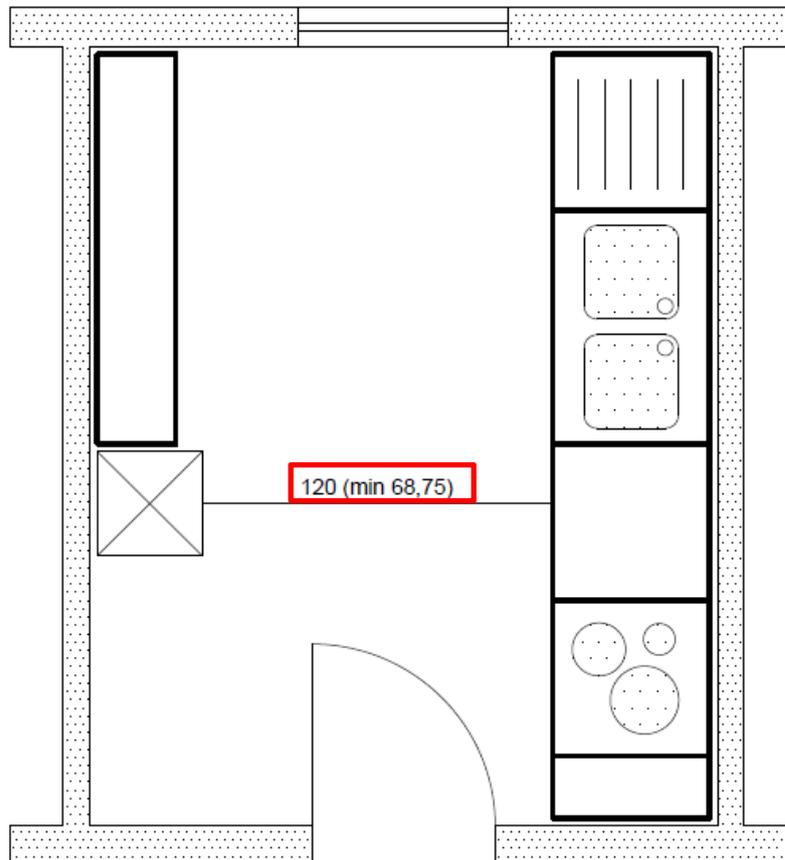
Anchura mínima entre obstáculos (cm). Planta. (Elaboración propia)
